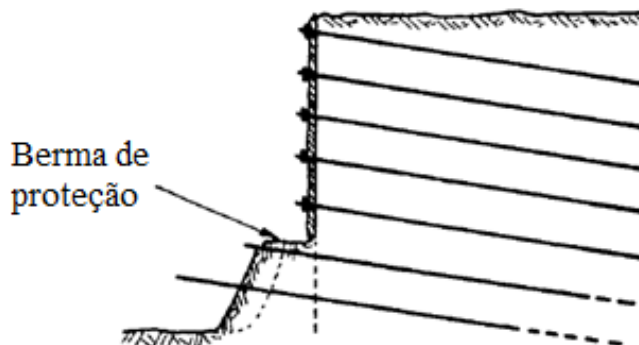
Execução de grampos preliminarmente ao início da escavação das bermas (adaptado Clouterre, 1991)
